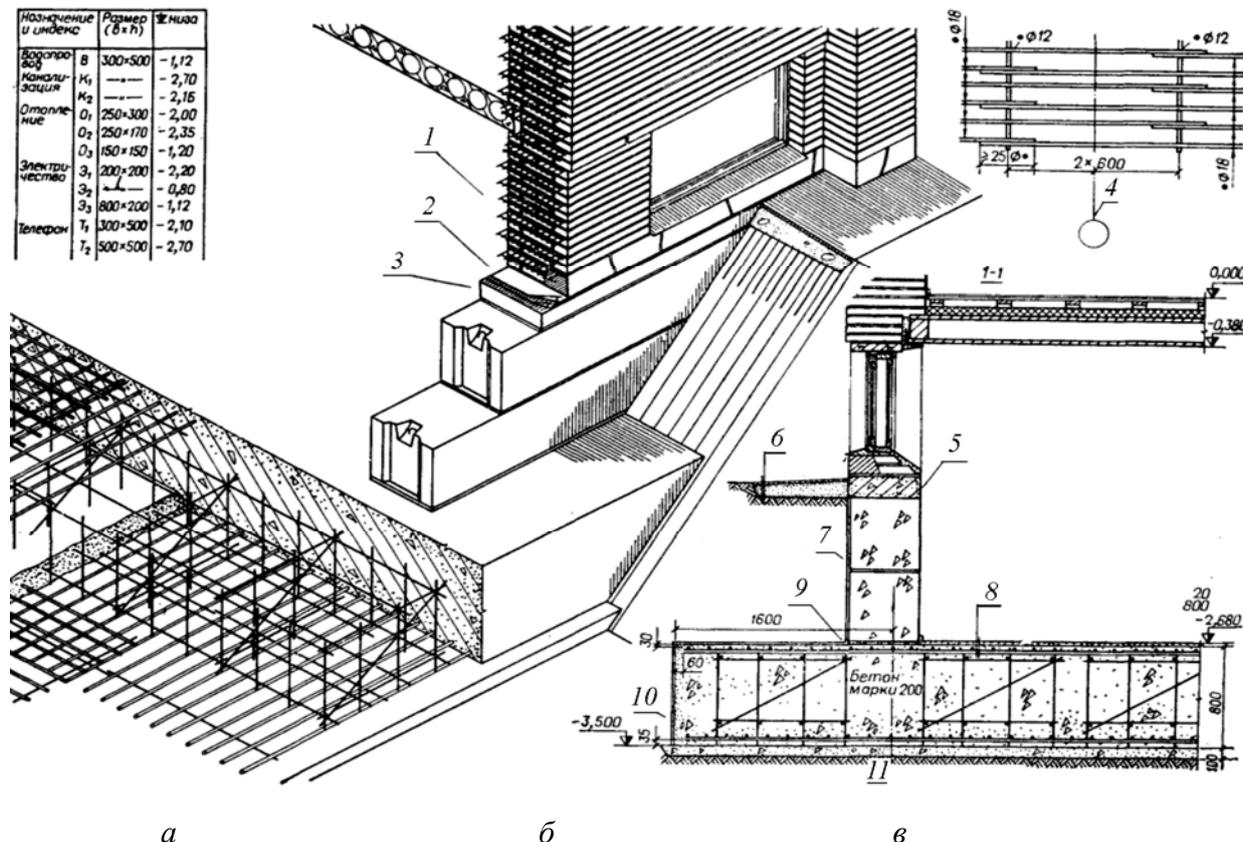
Сплошной фундамент: *а* — типы отверстий; *б* — общий вид фундамента у продольной стены; *в* — план сопряжения сеток плиты основания: 1 — основные сетки армирования кладки из $\bullet \text{ } \varnothing 5$ с ячейкой 50×50; 2 — противокapиллярная гидроизоляция из двух слоев толя на битумной мастике; 3, 5 — монолитный ж/б пояс площадью сечения 510×140; 4 — ось несущей стены и стыка сеток; 6 — асфальт 30, щебень ≥ 150 с уклоном $i = 0,03$; 7, 10 — обмазка горячим битумом (2 раза); 8 — цементно-песчаный раствор марки 100 с железнением поверхности 20, ж/б плита основания 800; 9 — цементный раствор состава 1 : 2, подготовка из бетона марки 100
